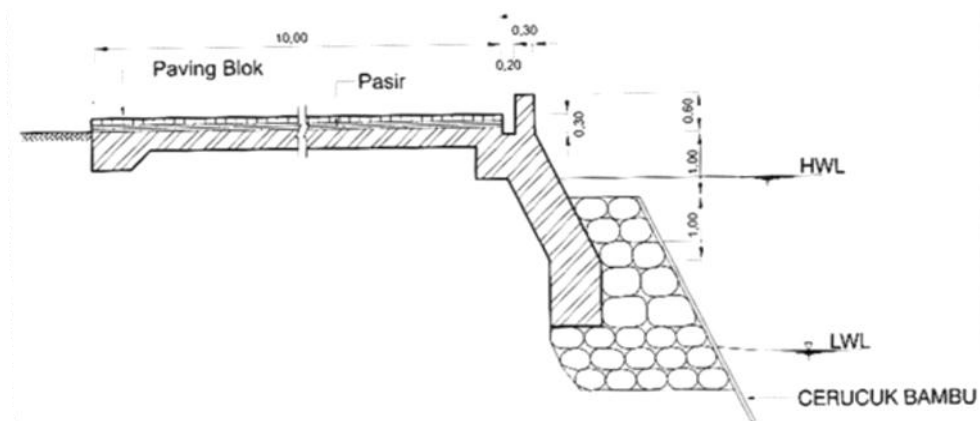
Potongan melintang tembok laut dari susunan blok beton teratur
